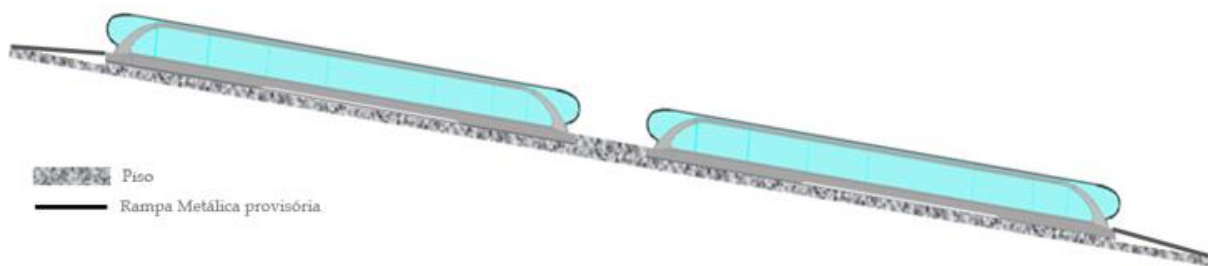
Layout das esteiras rolantes com rampas metálicas provisórias
